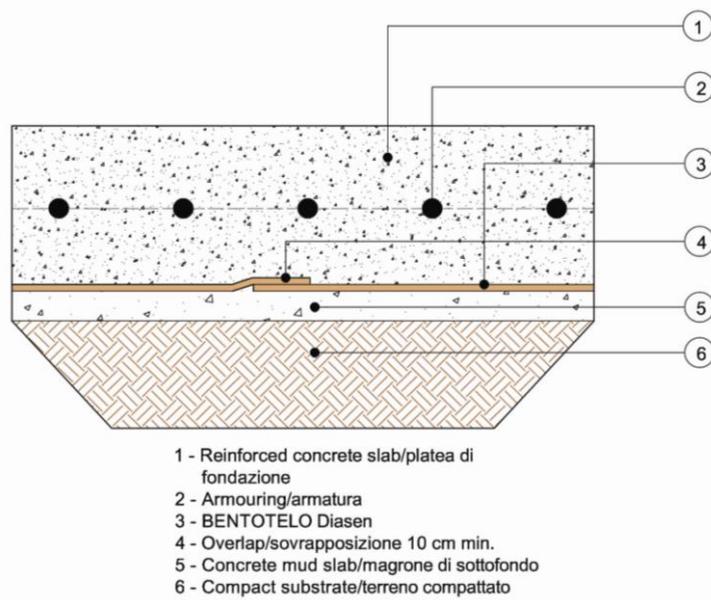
Particolare tecnico dell'impermeabilizzazione della platea di fondazione con sistema bentonitico.
